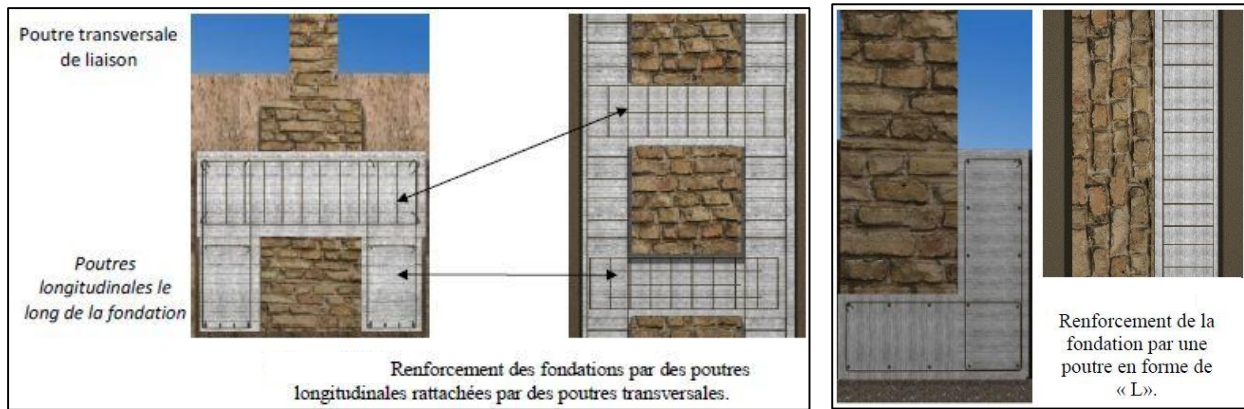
renforcement d'une fondation sans augmentation de la surface de la semelle
